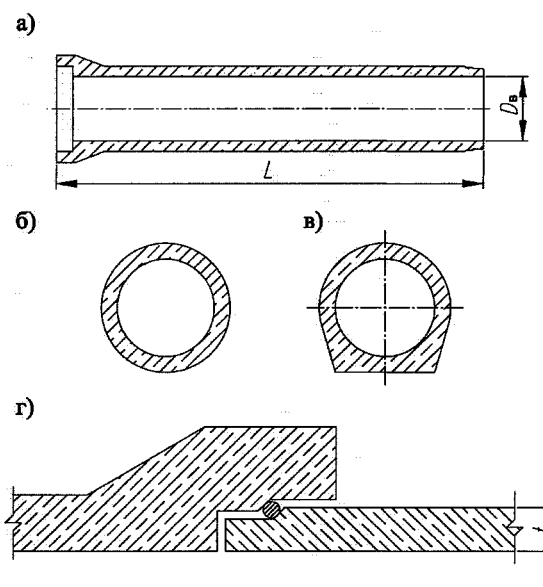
Конструкция железобетонных безнапорных труб: а – продольное сечение трубы; б – поперечное сечение цилиндрической трубы; в – поперечное сечение трубы с подошвой; г – гибкий раструбный стык; L – длина трубы; D_b – внутренний диаметр; t – толщина стенки
